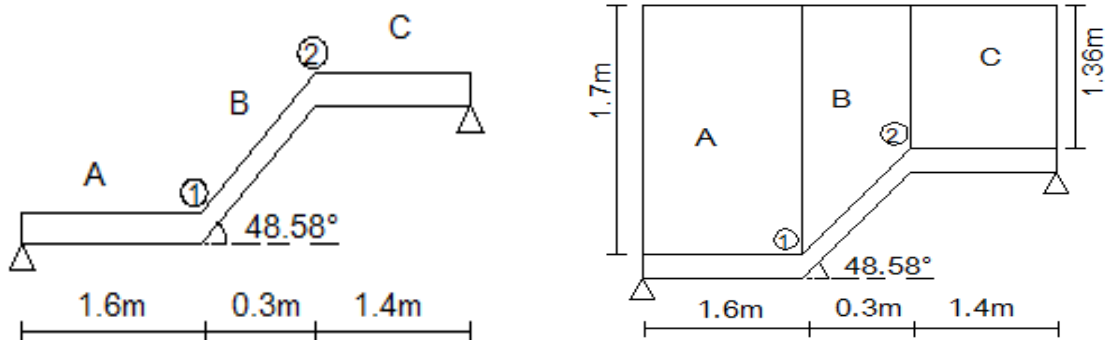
Schéma statique de la poutre palière brisée.
